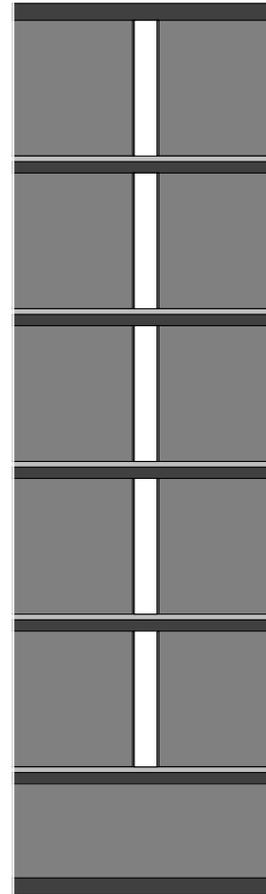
Geberit Installationssystem mit einer Brandlast pro Stockwerk = 632 MJ
